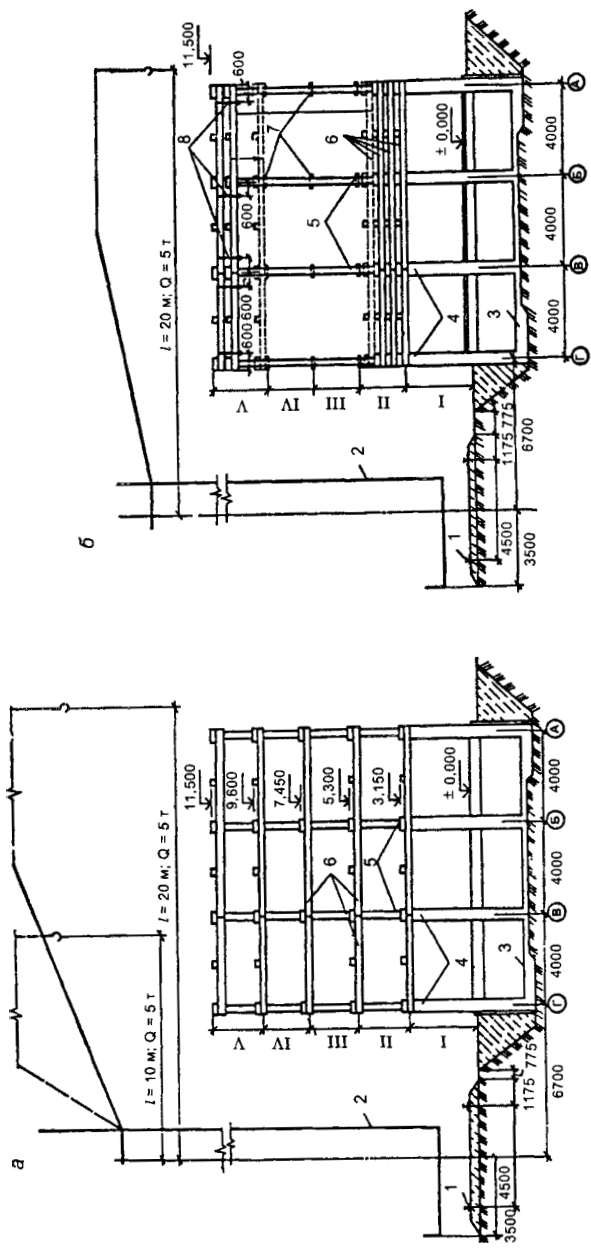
Монтаж типовой сборной железобетонной вентиляционной градирни:
